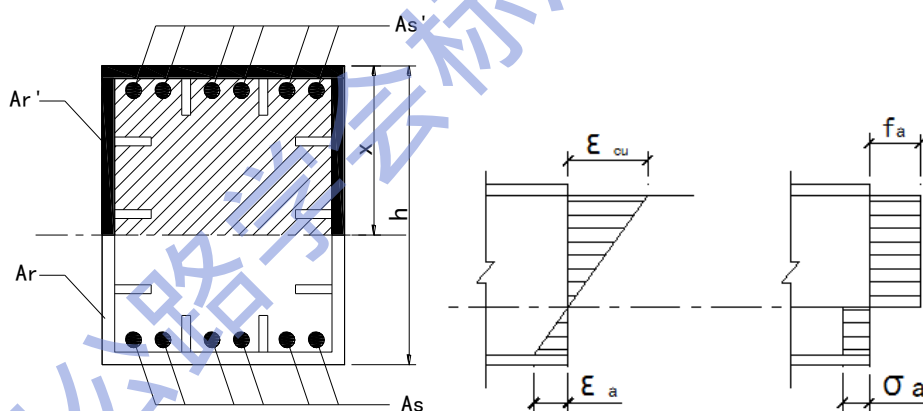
钢壳-混凝土组合塔正截面承载力计算参数示意
